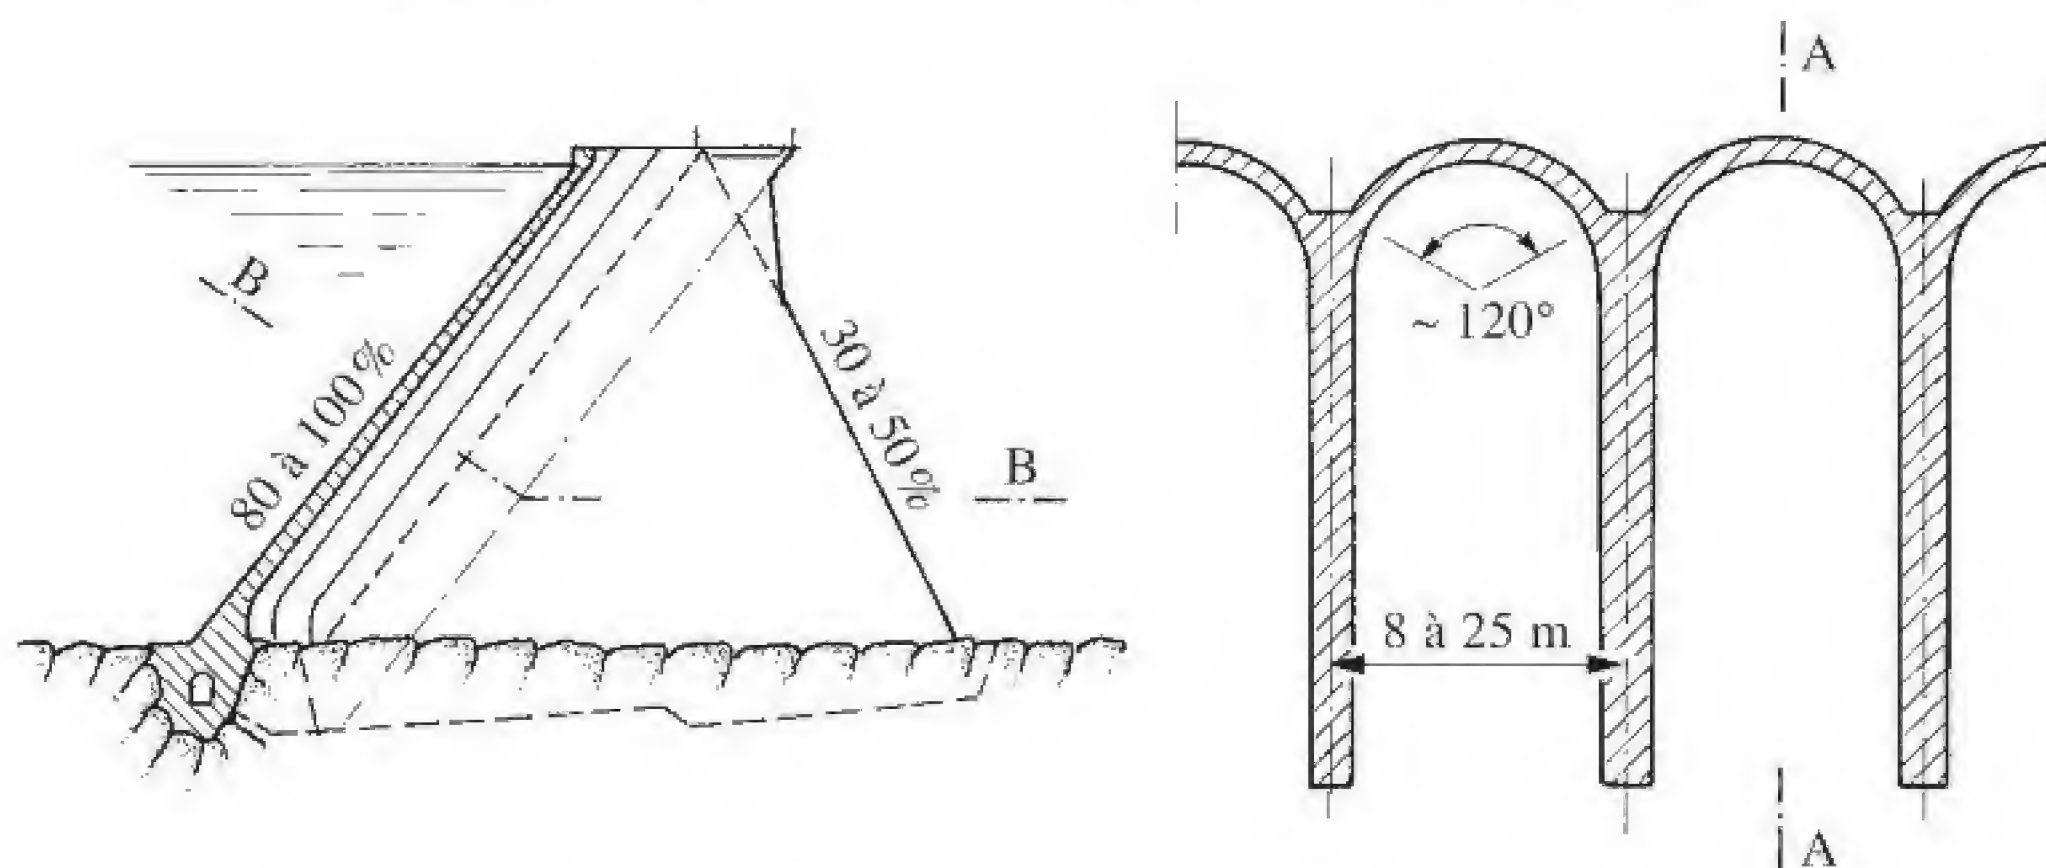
Barrage à voûtes multiples : profil-type et section horizontale.
